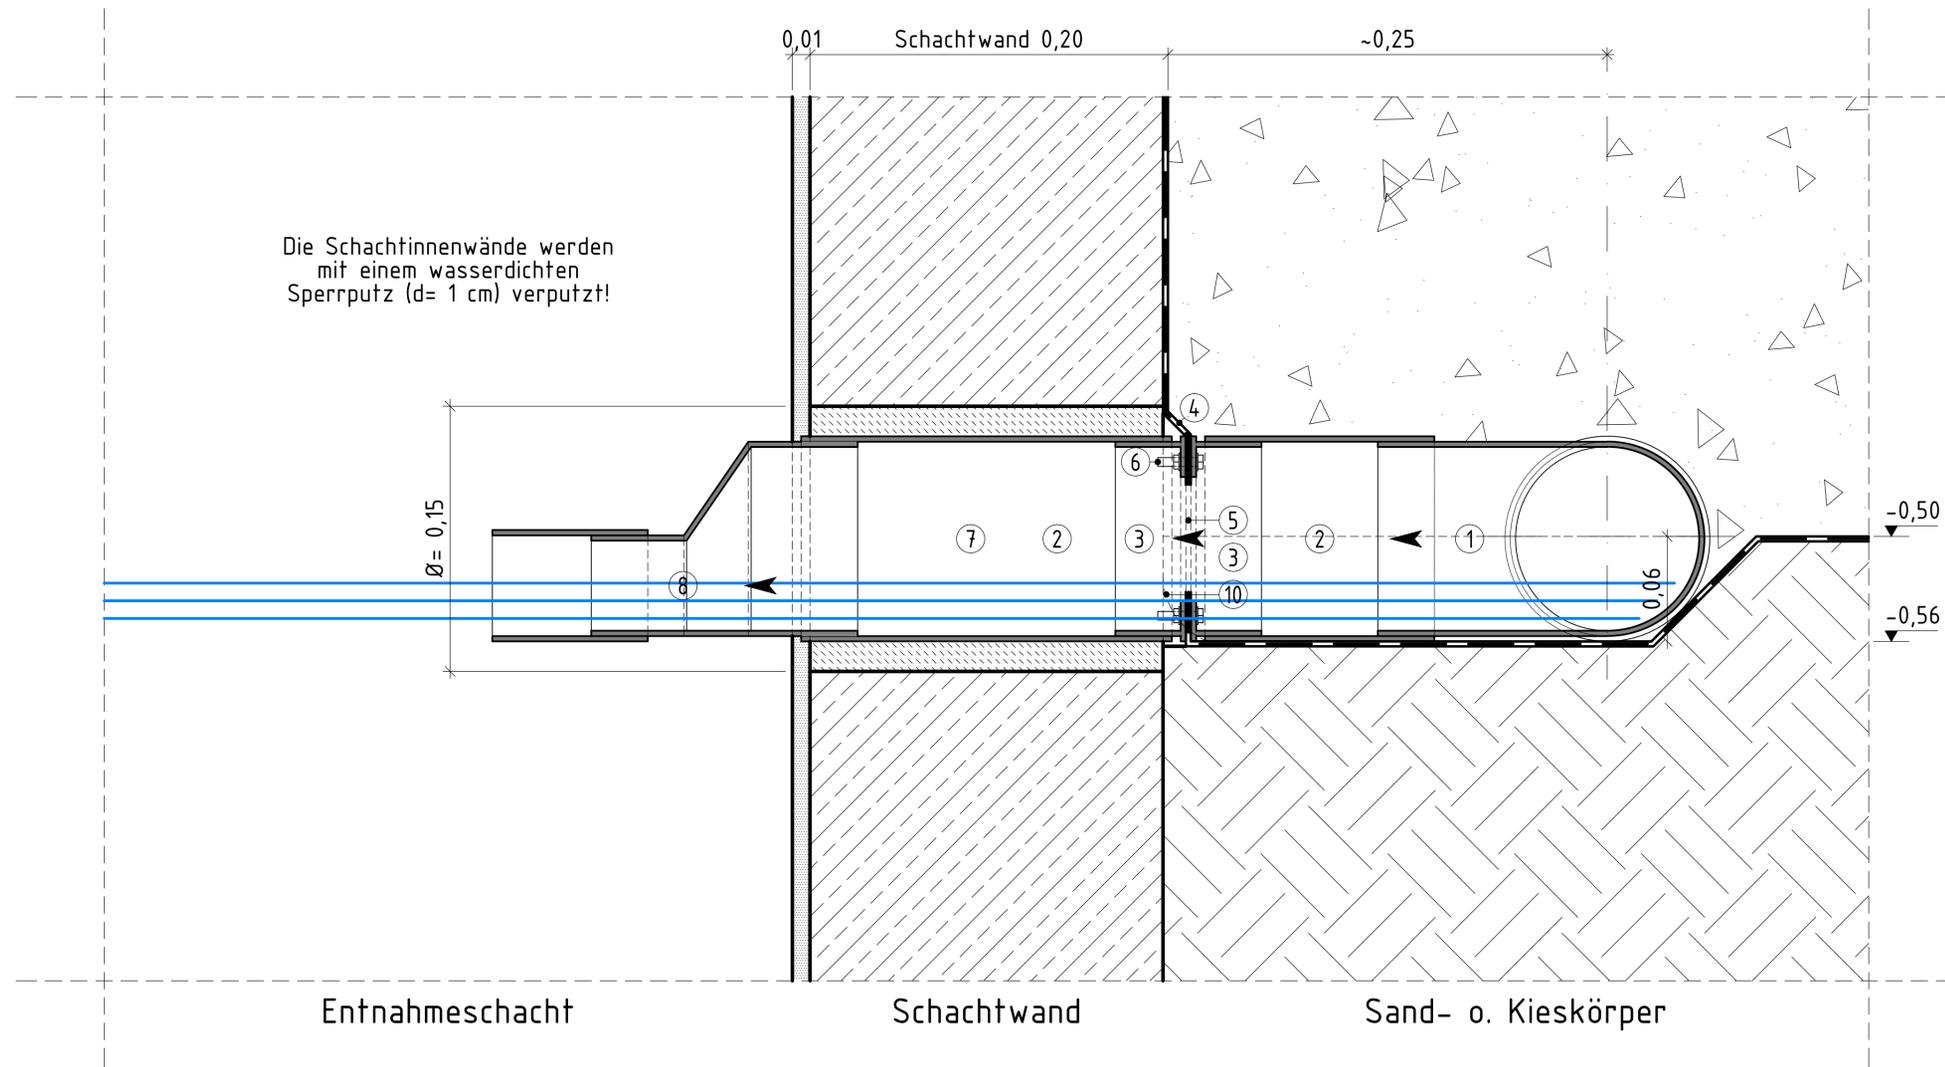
# Detail B: Ablauf am Entnahmeschacht Horizontal durchströmte Pflanzenkläranlage (vereinfachte Bau- und Betriebsform)
